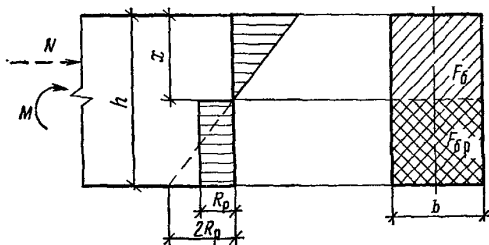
Схема усилий и эпюра напряжений в сечении, нормальном к продольной оси изгибаемого (внецентренно-сжатого) бетонного элемента, рассчитываемого с учетом сопротивления бетона растянутой зоны
